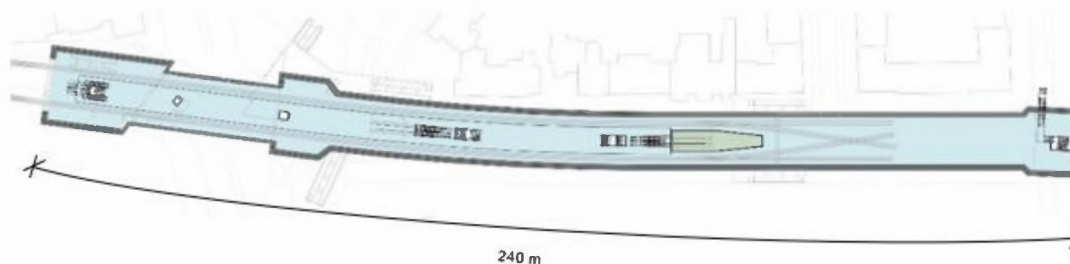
Hp Schlump, Var. I – Grundrisse
